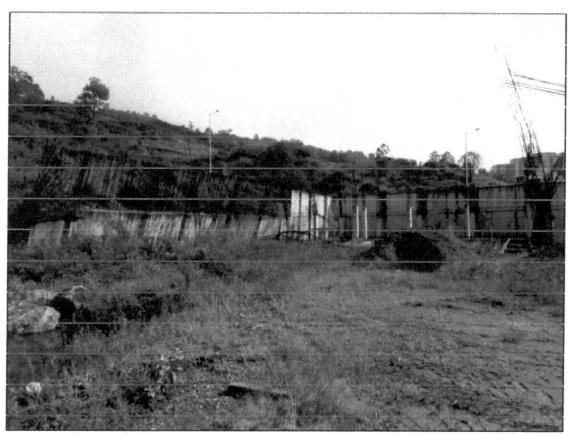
Vista de la obra en construcción y falla del muro de contención.
